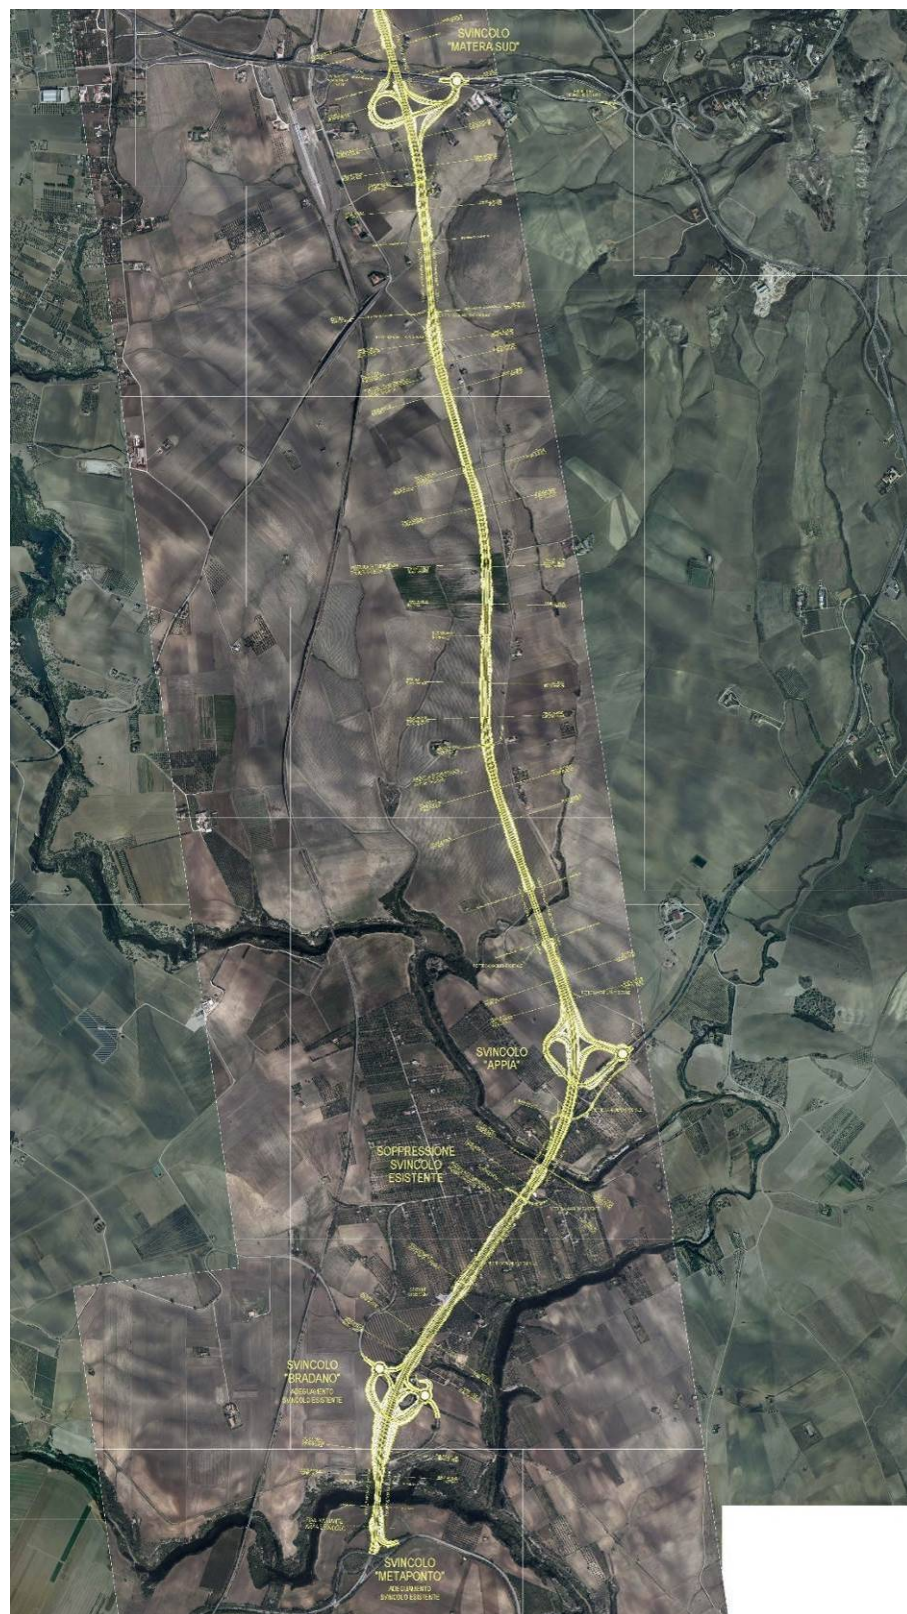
Planimetria progetto tratto Svincolo "Matera Sud" – Svincolo "Metaponto"
